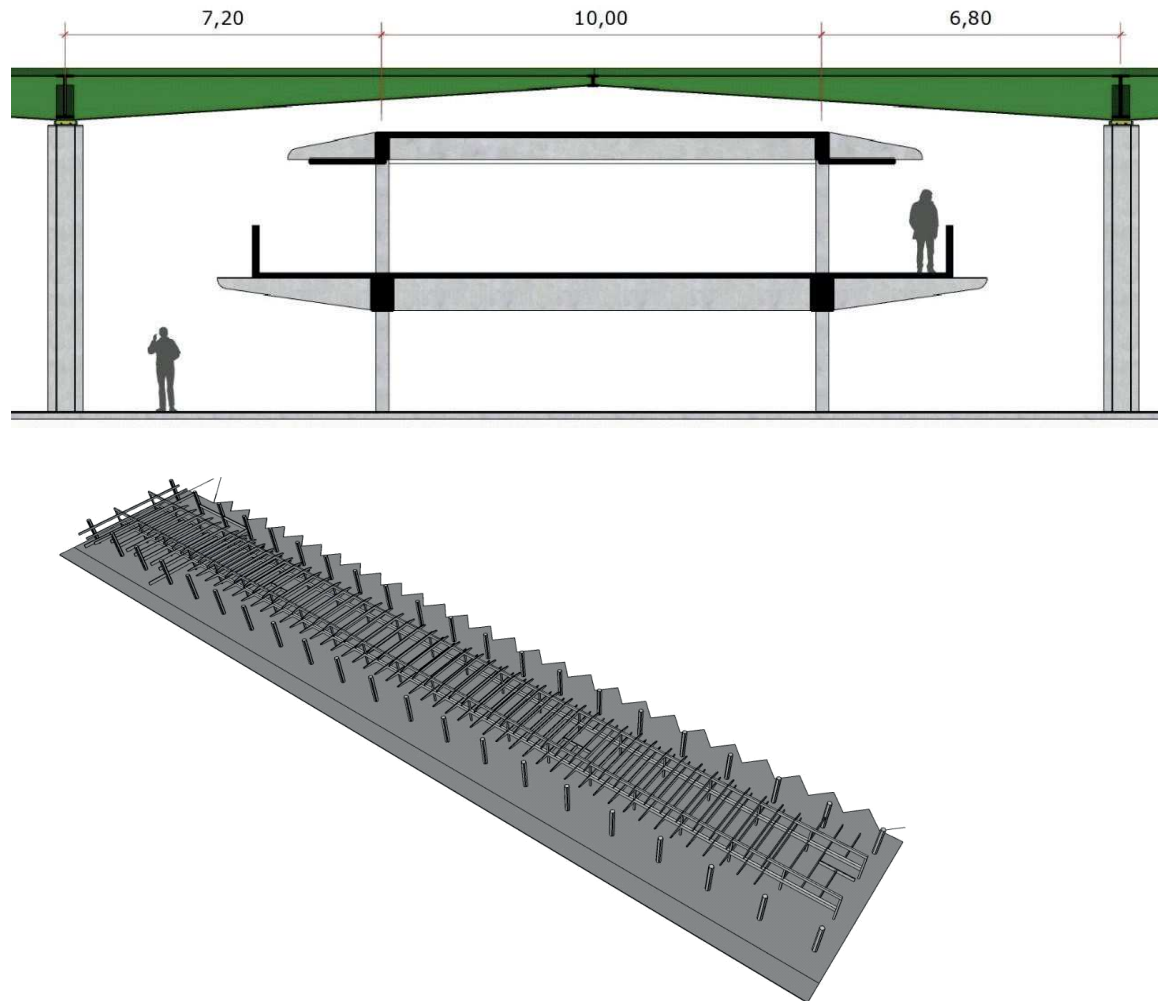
Fotos do local – vigas dos balanços do Volume Interno, corte e simulação 3D das vigas
